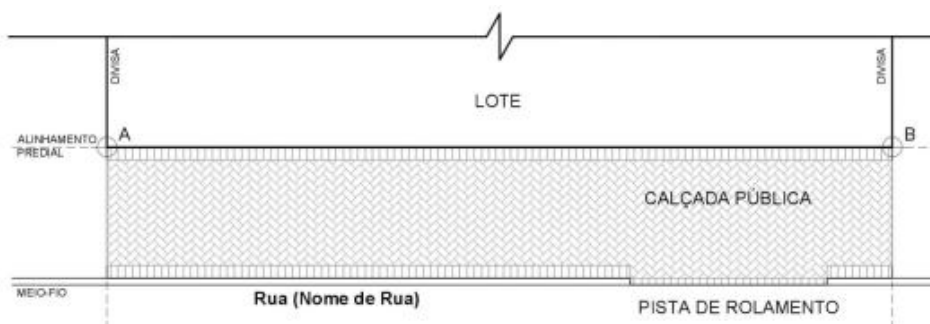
Planta esquemática para a definição da RN (sem escala)
